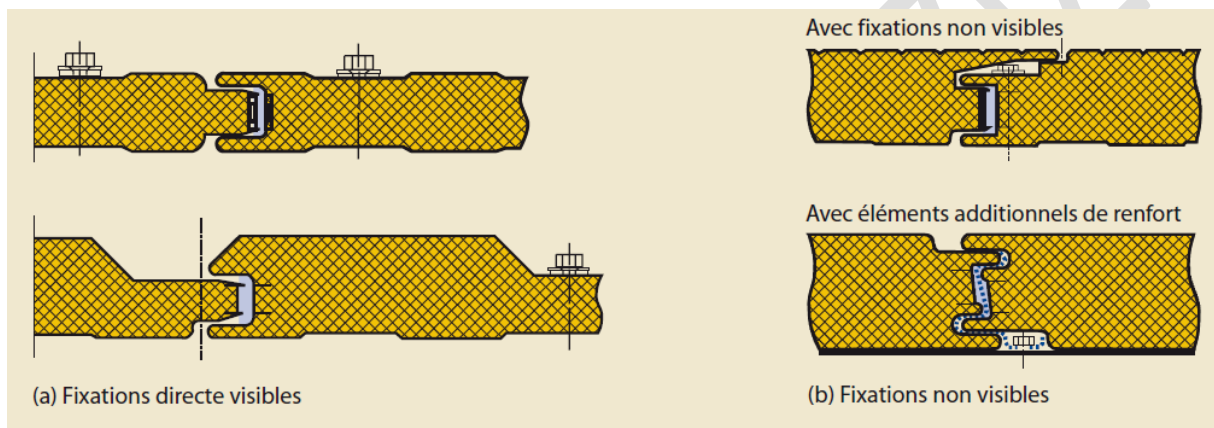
Exemples de modes de fixation pour façades en panneaux-sandwich
